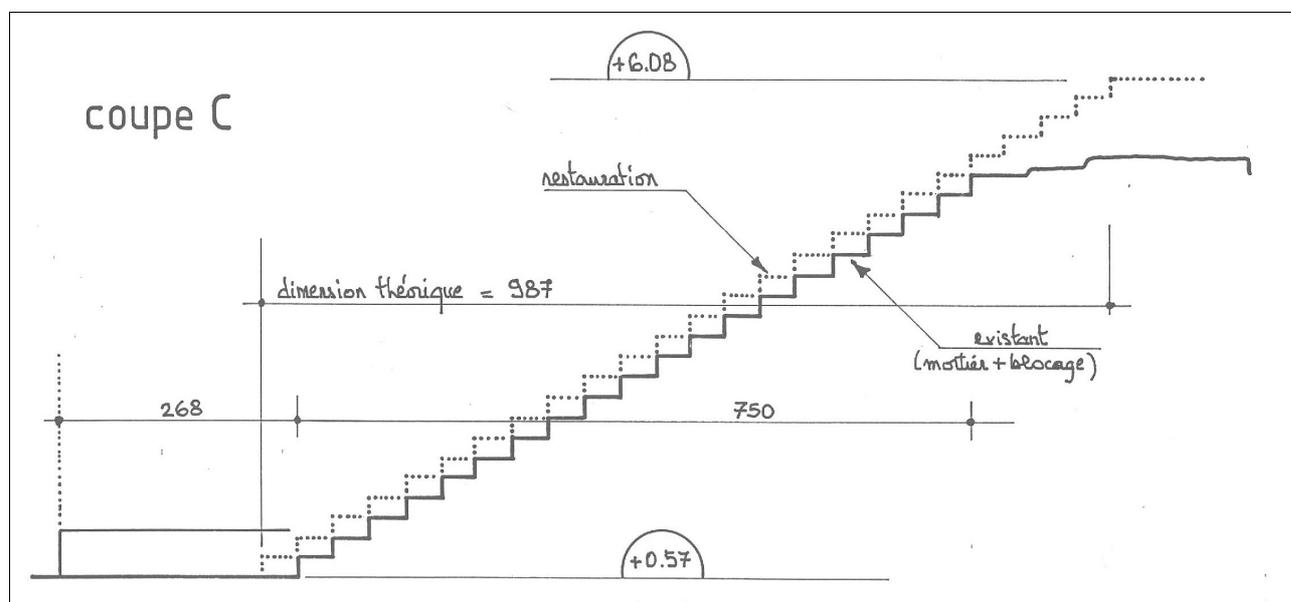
Relevés en secteur 3 : coupe sur l'escalier.
